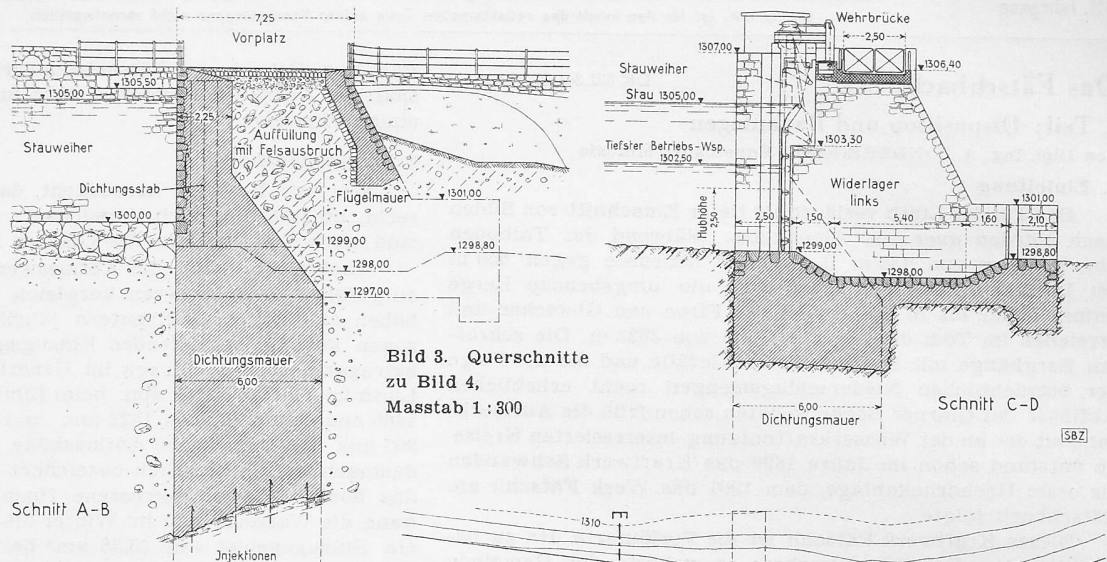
Querschnitte zu Bild 4, Masstab 1:300
